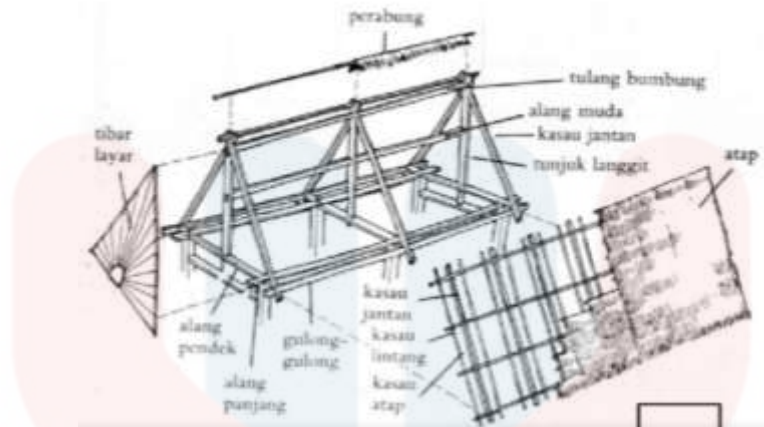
Penyambungan alang panjang, alang pendek dan tunjuk langit
